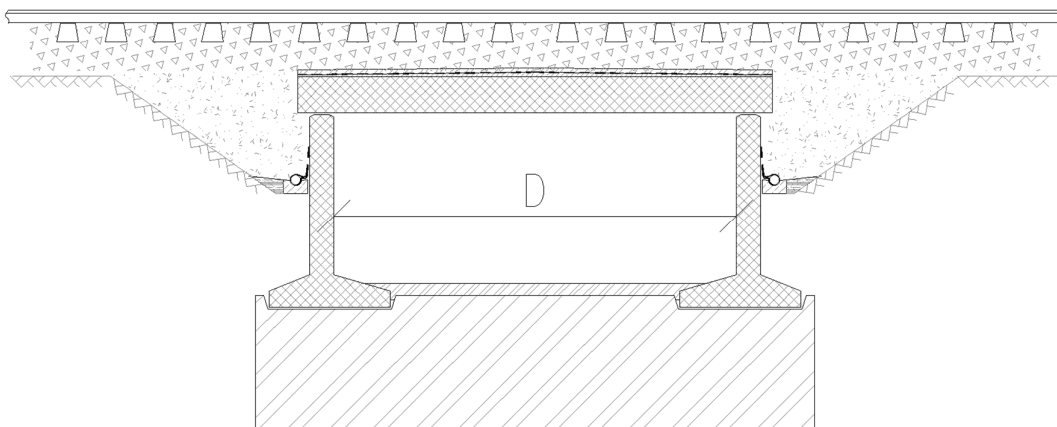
Exemplu de podeț realizat din dale prefabricate din beton armat
